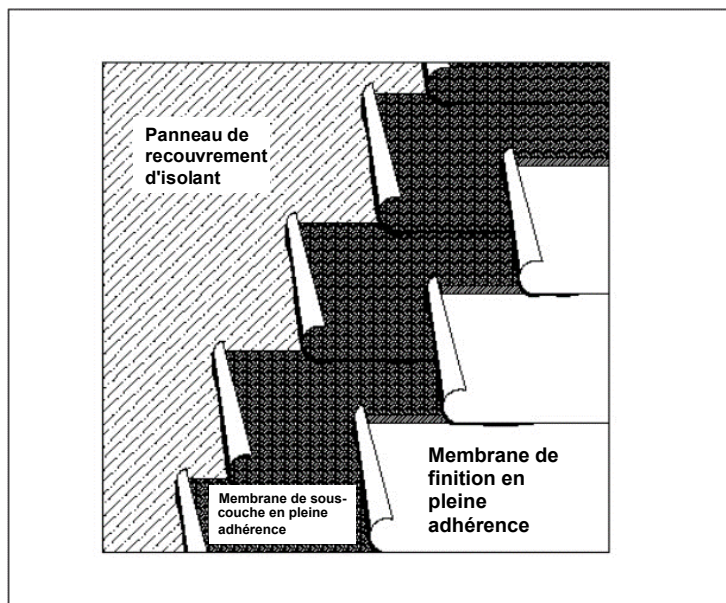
Détails de l'installation du système de membrane de toiture de bitume modifié au SBS
